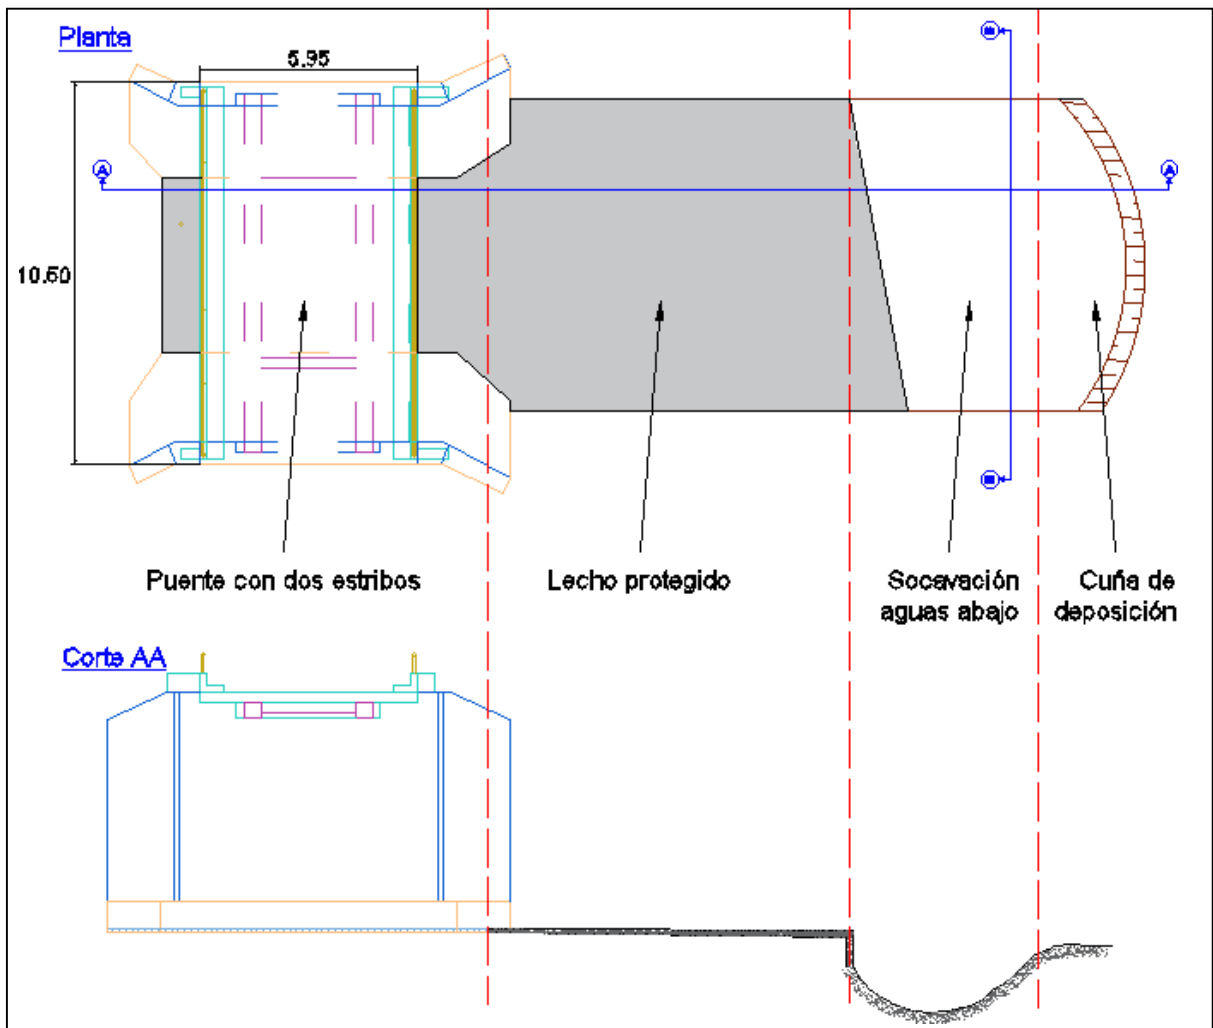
Detalle en la zona aguas abajo de la zona protegida del puente Plan Manzanas.
